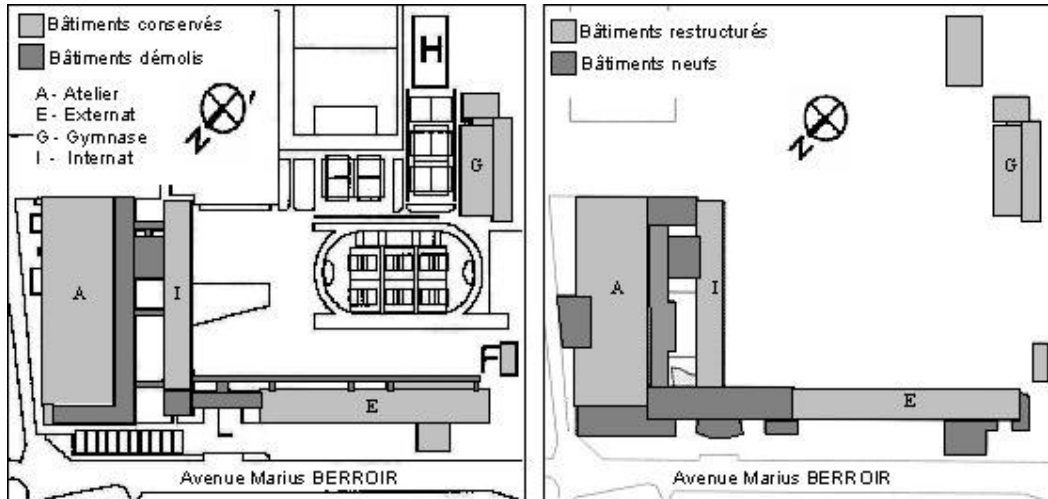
Plans masse du projet avant restructuration (à gauche) et après restructuration (à droite)
